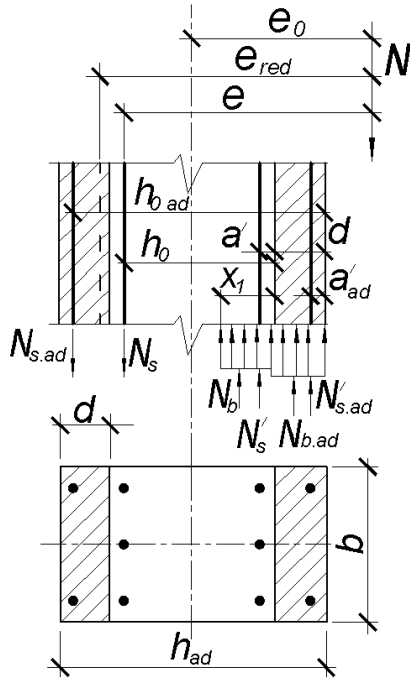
Розрахункова схема підсилення позацентровано-стиснутого перерізу
